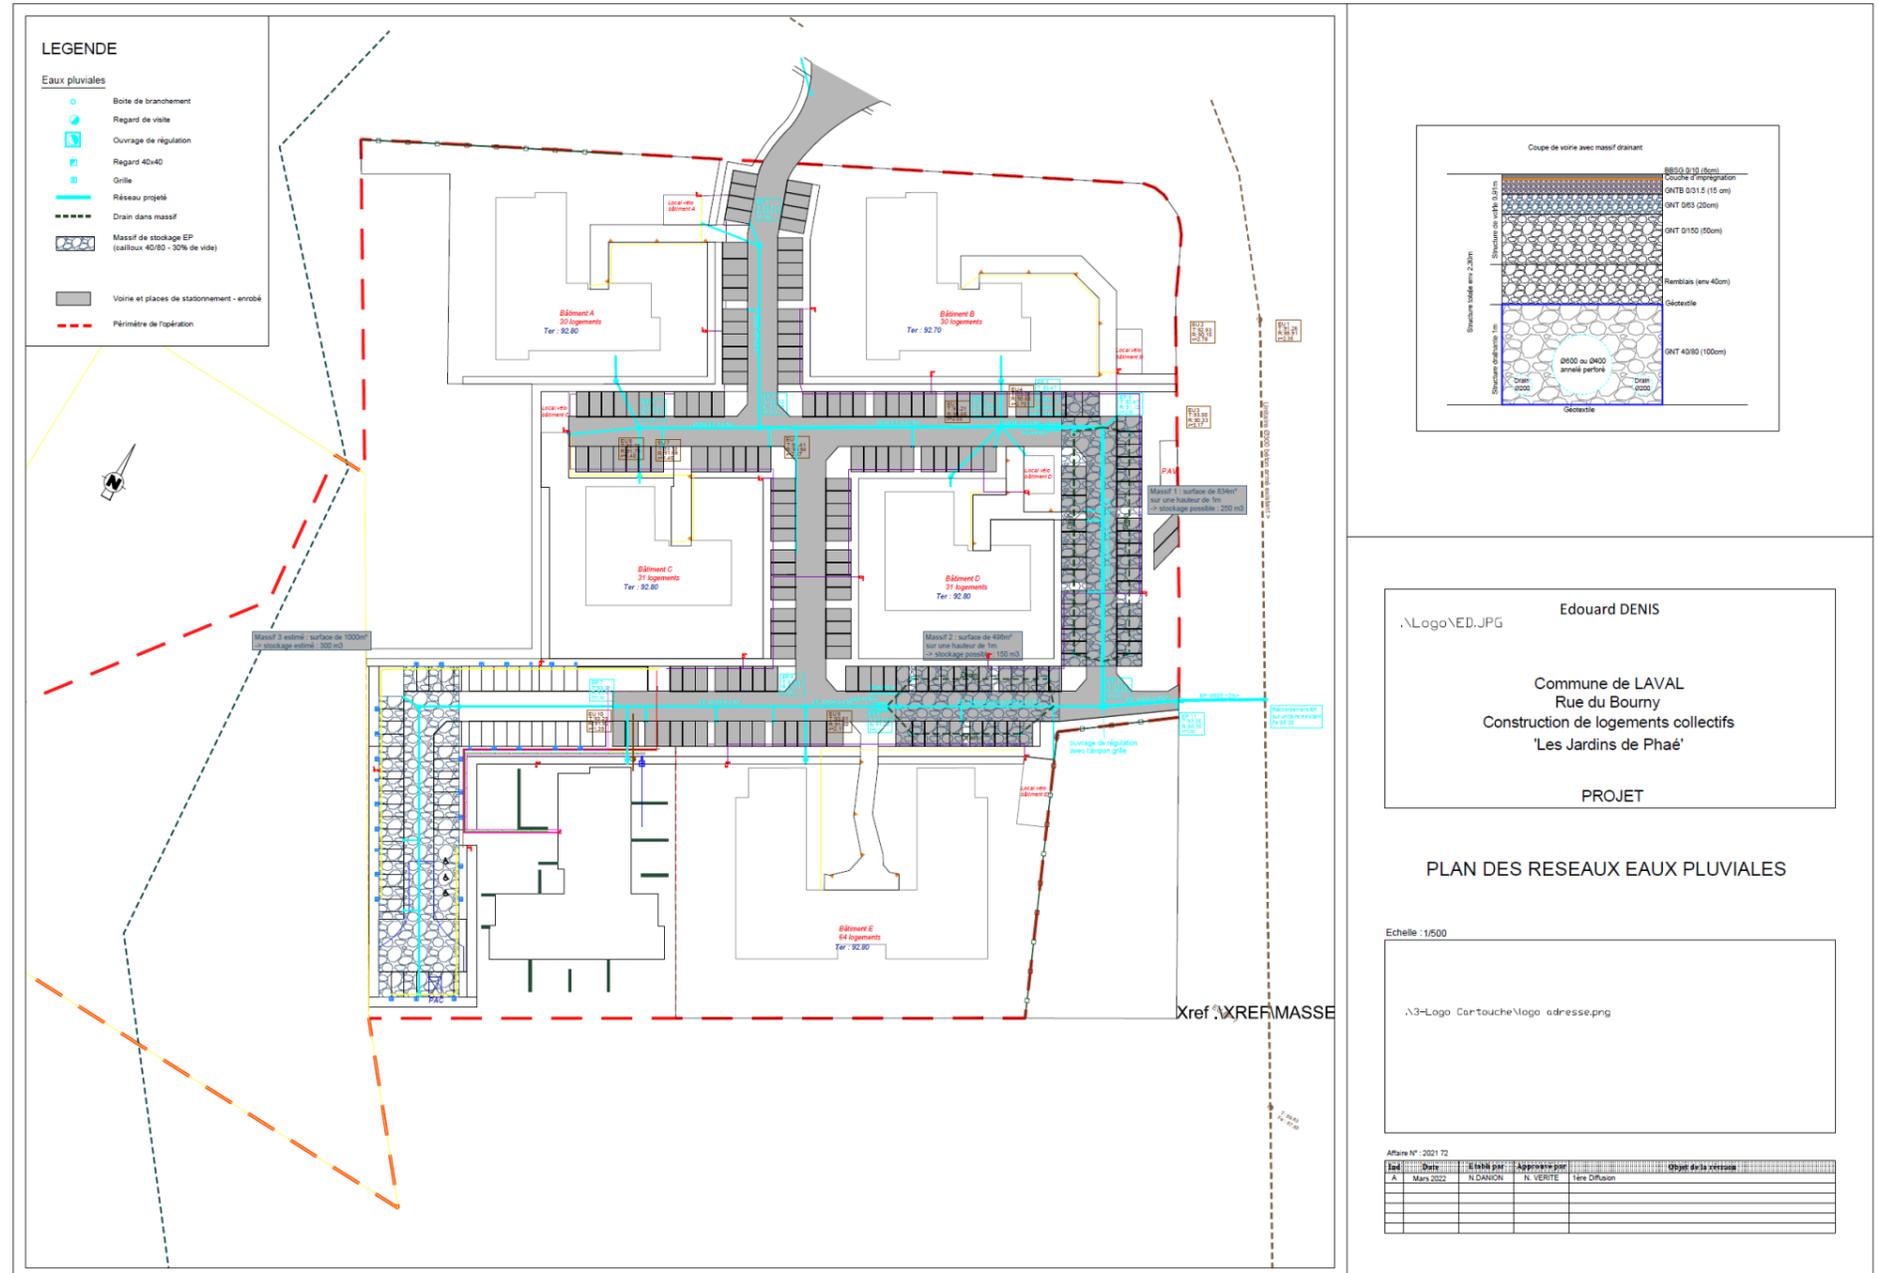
plan de gestion des eaux pluviales – Source : CPE35 – Clément Poirier – INFRA CONCEPT
